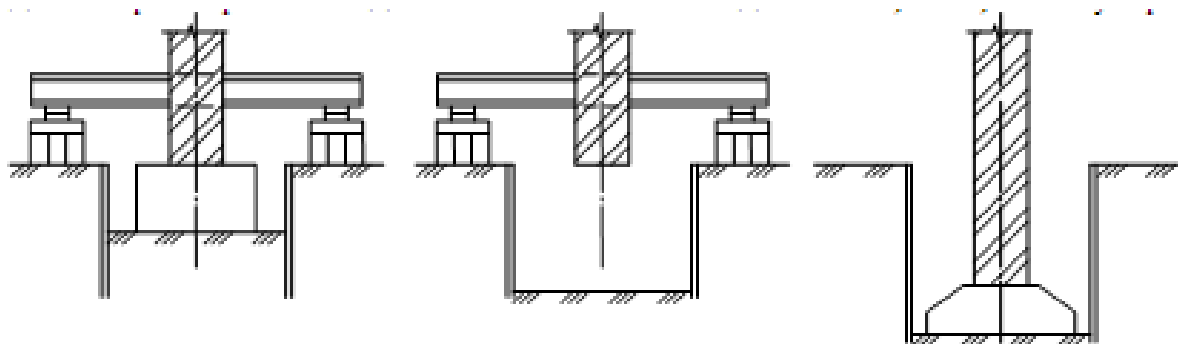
Перебудова стрічкового фундаменту з розбиранням старої кладки фундаменту
